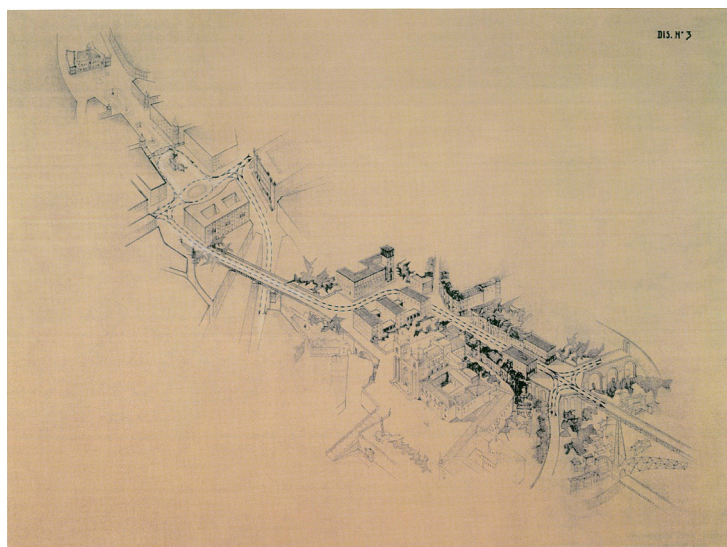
Ligação da Ponte à Praça da Liberdade. Solução 10 de Arq. G.Muzio.
